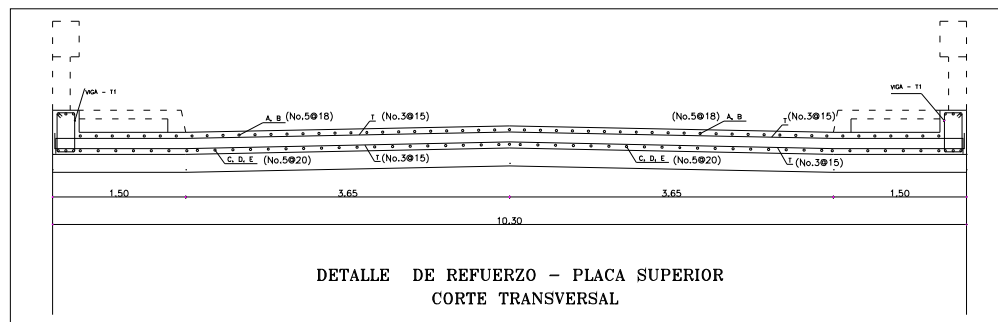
Detalle refuerzo tipo A y armado del refuerzo para la placa superior.
